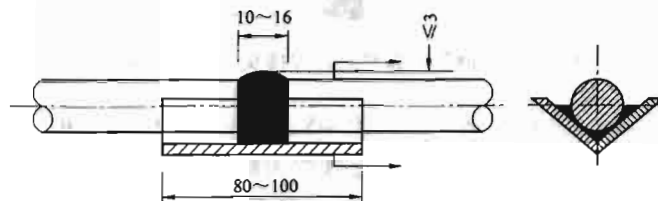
钢筋熔槽帮条焊接头 (单位: mm)
